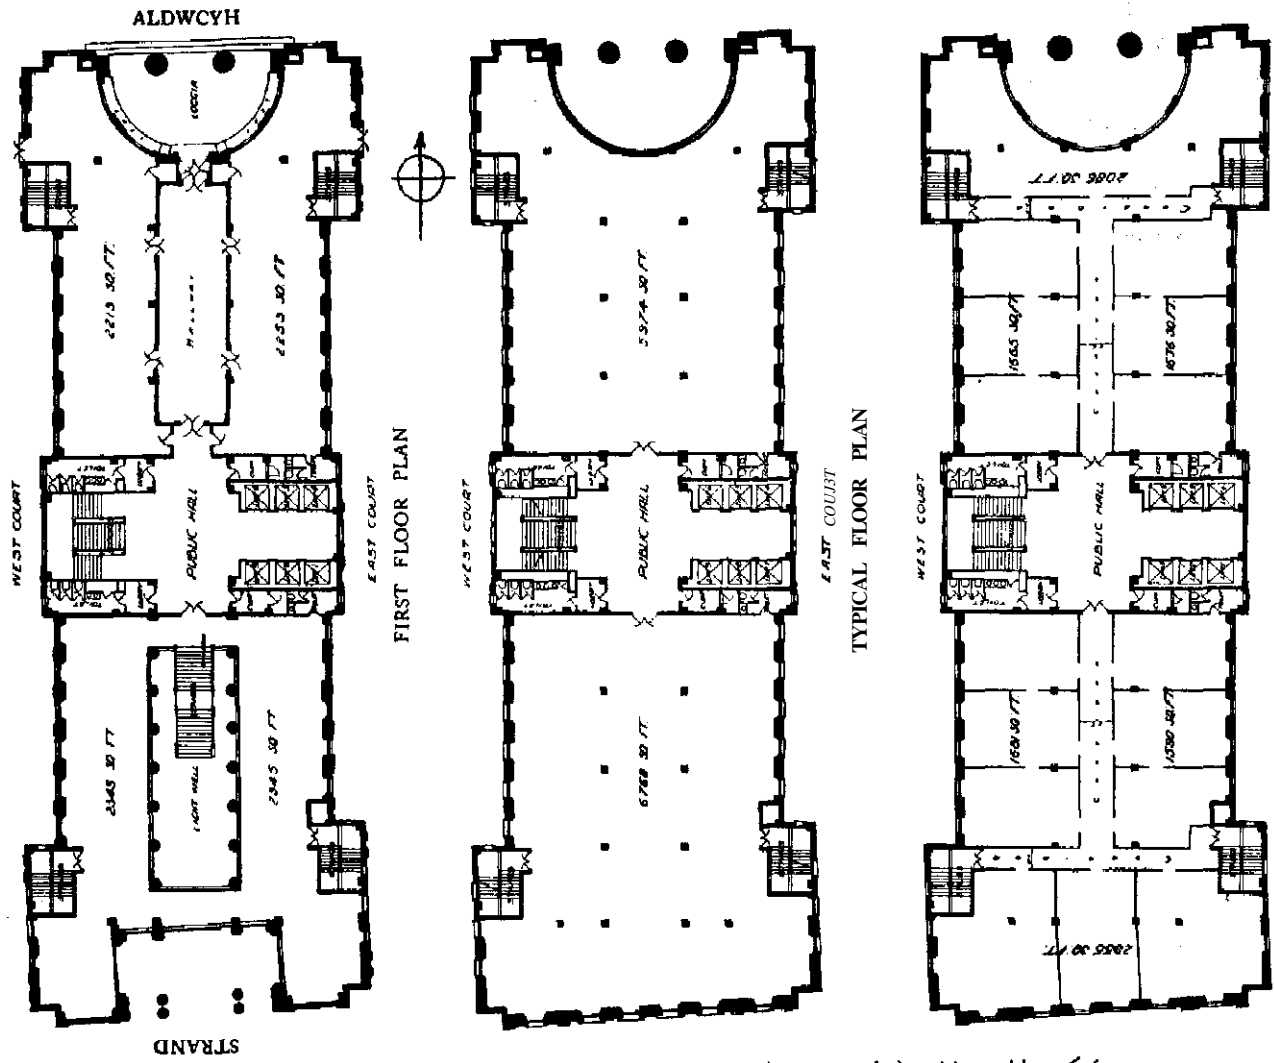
(oben) / Grundrisse des Bush-Hauses / Abb. 6 (unten) / Lageplan des Bush-Hauses am Kopfe des 1899-1905 geschaffenen Straßendurchbruchs zwischen Holborn und Strand (Abbruch von 600 Häusern, Kosten 100 Mill. Mark). Das Bush-Haus wurde erst 1923 erbaut.
